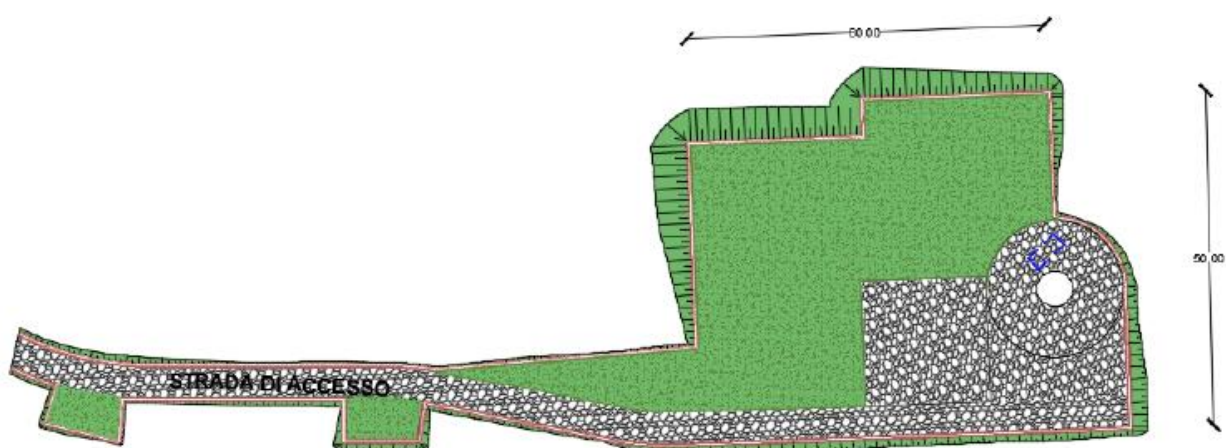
Planimetria piazzola tipo in fase di esercizio
